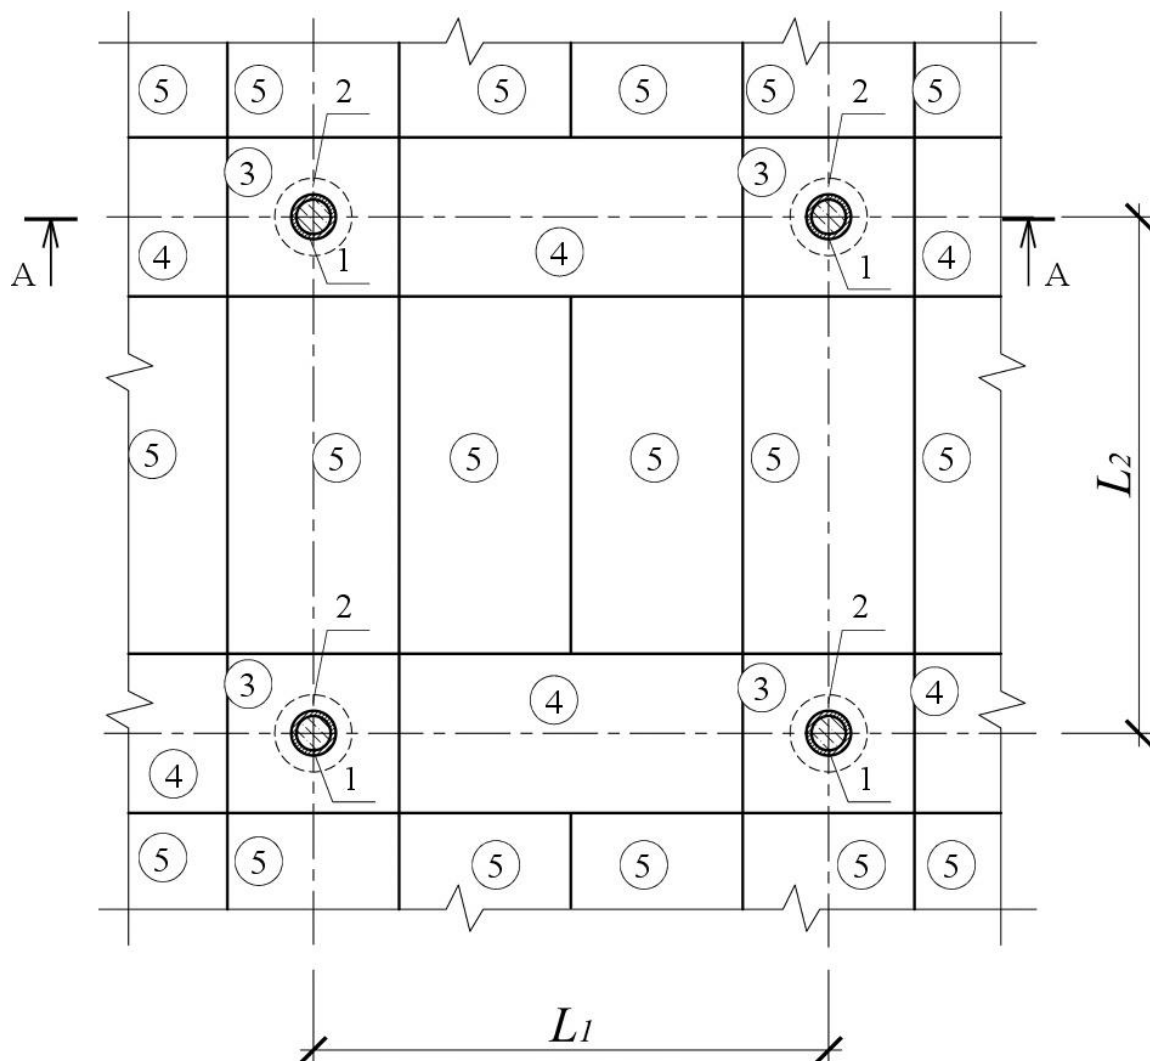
Фрагмент збірного сталезалізобетонного безбалкового перекриття:
